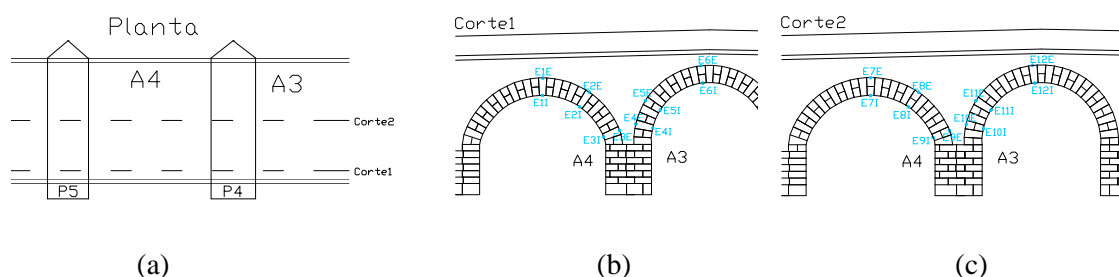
Posicionamento de extensómetros. Planta parcial, alinhamentos central e lateral
